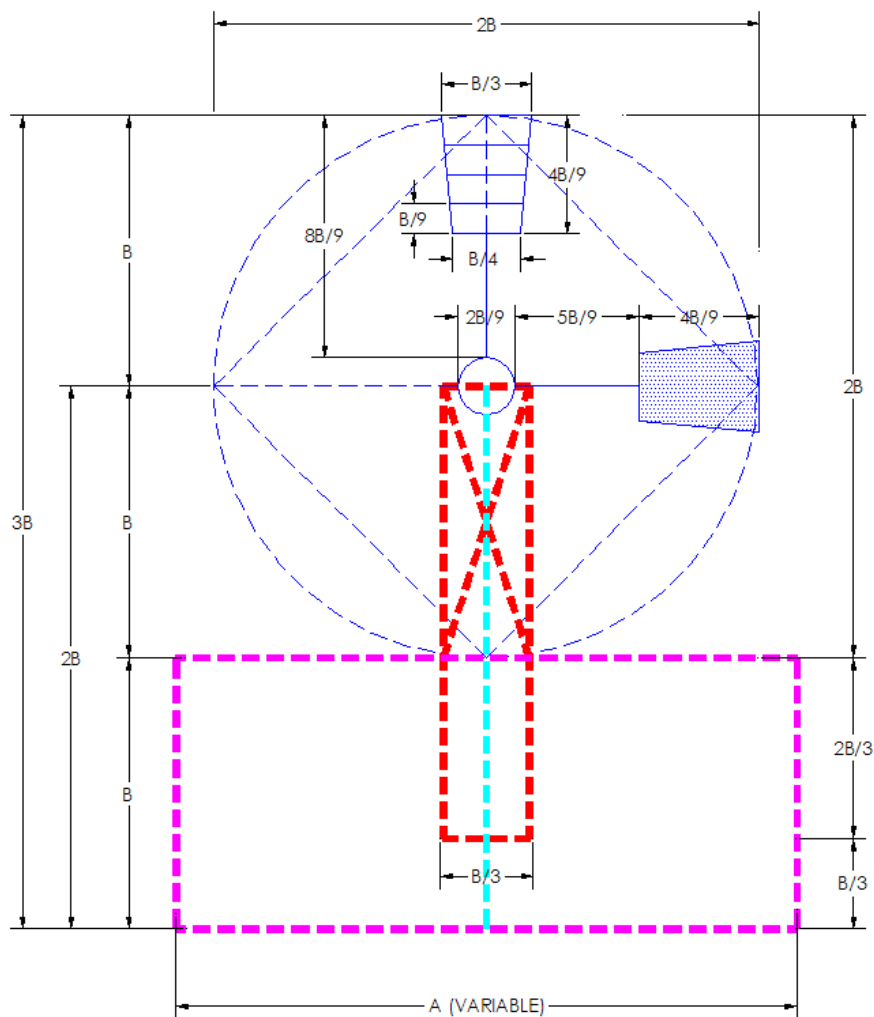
Proporciones geométricas del edificio y del rotor de aspas del molino de viento "Sistema Ortega"
